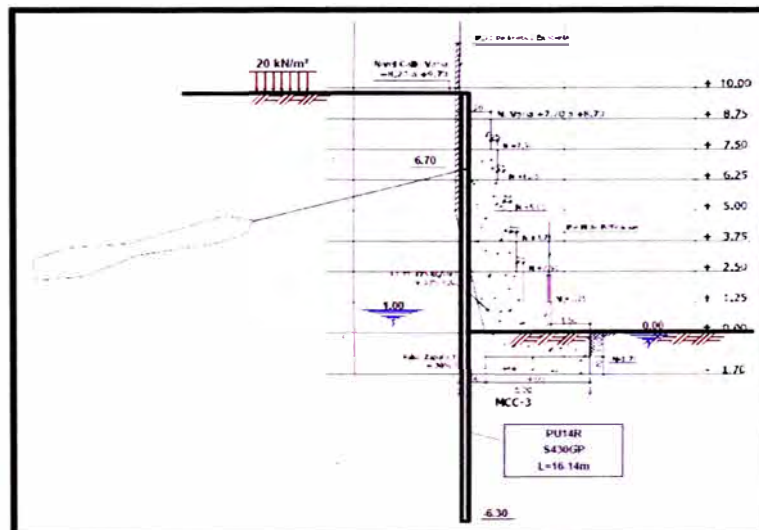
Aplicación de las tablestacas en construcción de muros de contención
